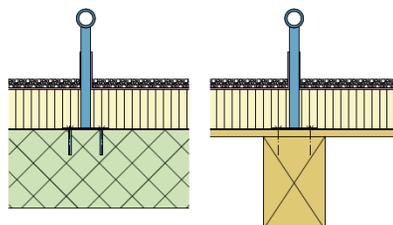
Classe d'équipement 1: PAI monté sur un toit plat avec isolation thermique, variante sur du béton et sur une charpente
